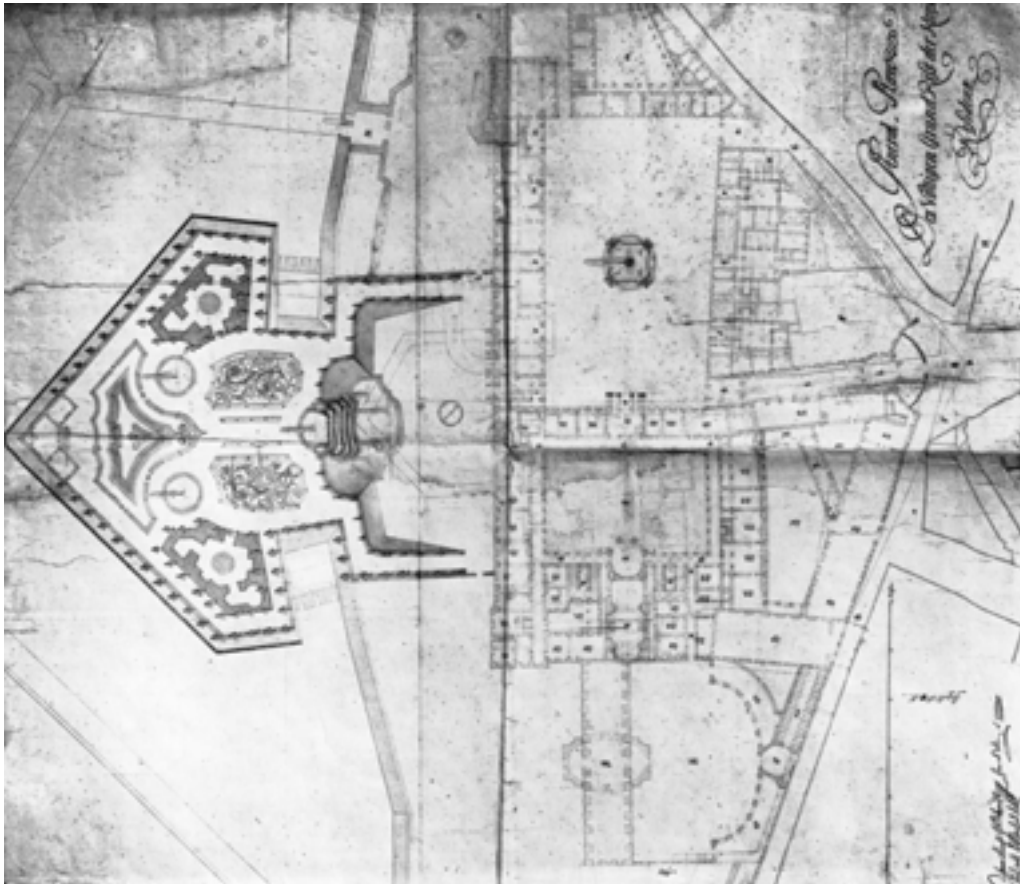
Die Hofburg in Wien. Grundriss für den Umbau der Gesamtanlage.
